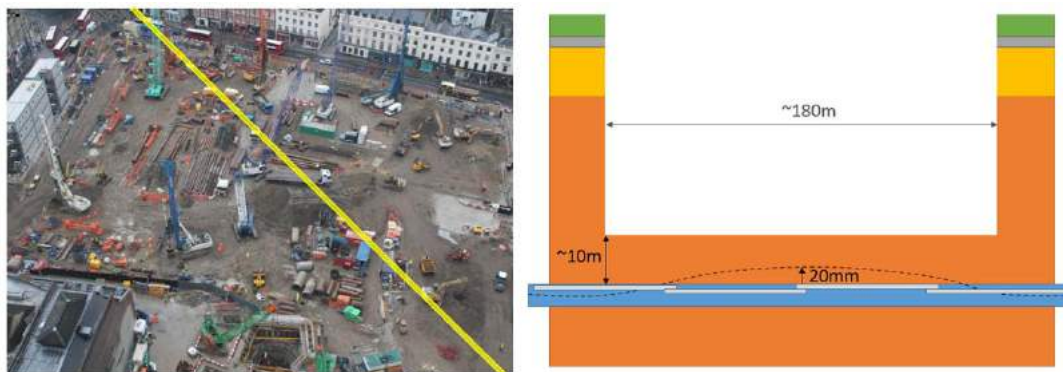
Vista aérea da escavação e projeção do traçado do túnel de esgoto. Seção tipo da escavação a 30 m de profundidade em argilas com características expansivas (cor laranja).
